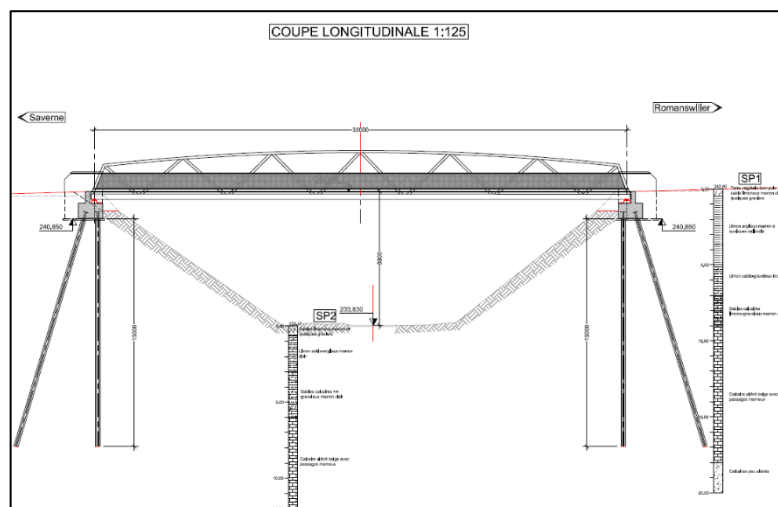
Coupe longitudinale ; Passerelle à créer
